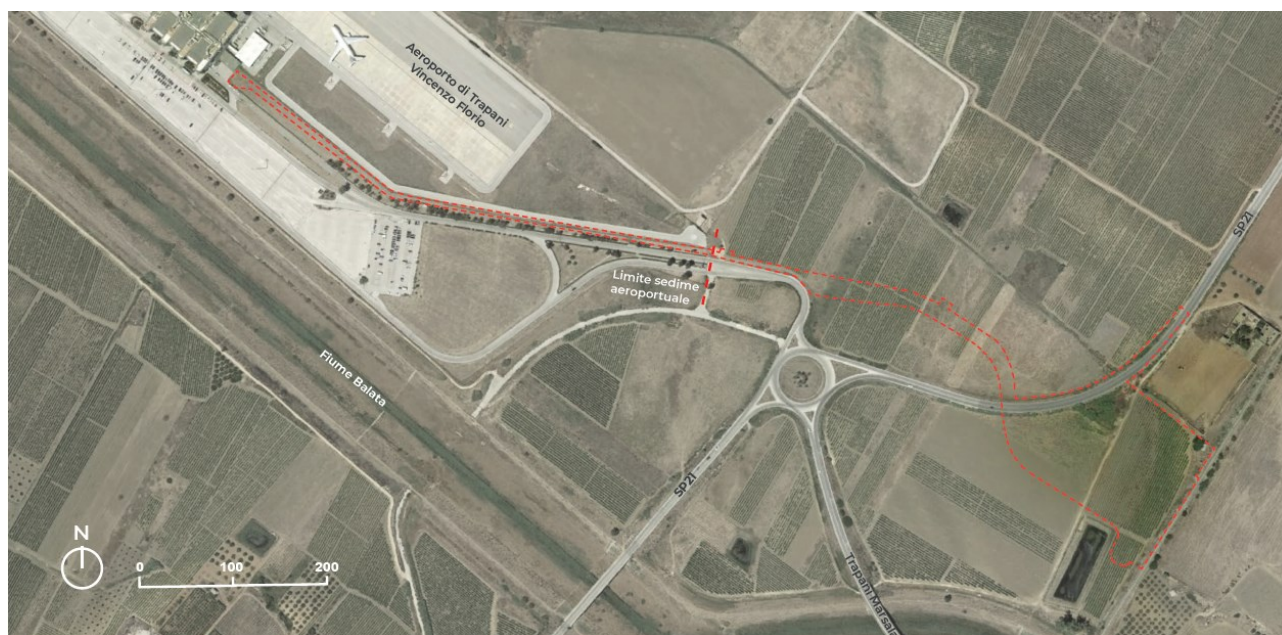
Planimetria generale dell'area di intervento. Situazione ante operam; in rosso le aree di progetto. Fonte "Book soluzioni architettoniche" allegato alla Lista di controllo.
